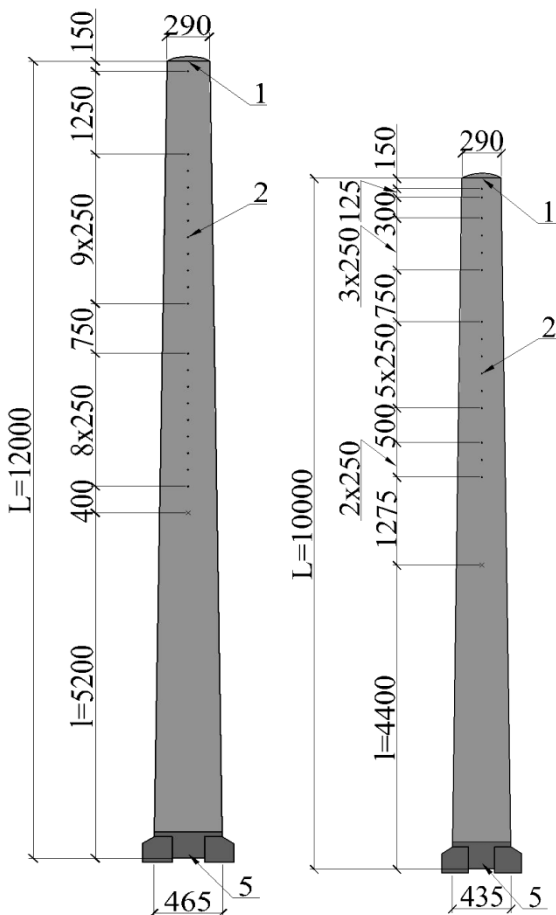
Стойки и их основные размеры: 1 – верхняя заглушка; 2 – отверстия для установки закладных деталей, крепления консолей и кронштейнов; 3 – отверстия для вентиляции; 4 – нижняя заглушка; 5 – опорный башмак для крепления стойки к фундаменту анкерными болтами.
